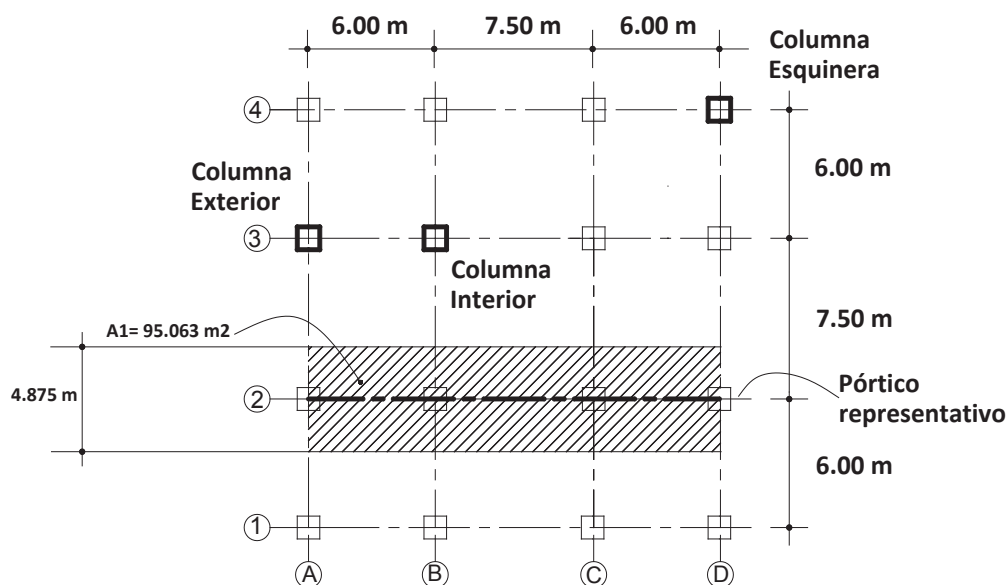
Planta característica y Área tributaria de pórticos
